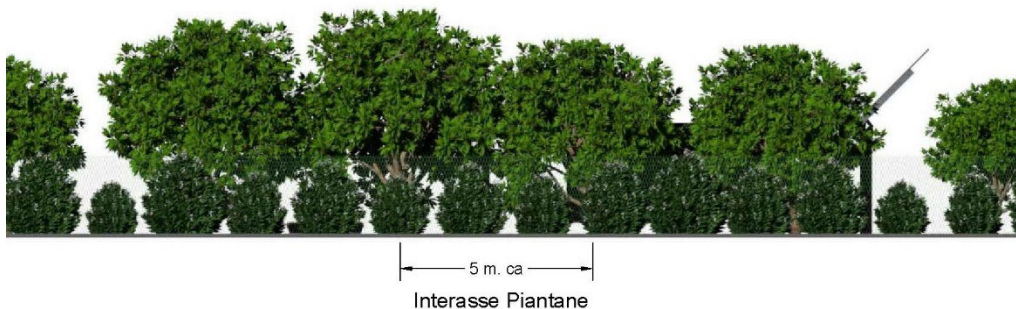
Prospetto recinzione perimetrale con mitigazione
